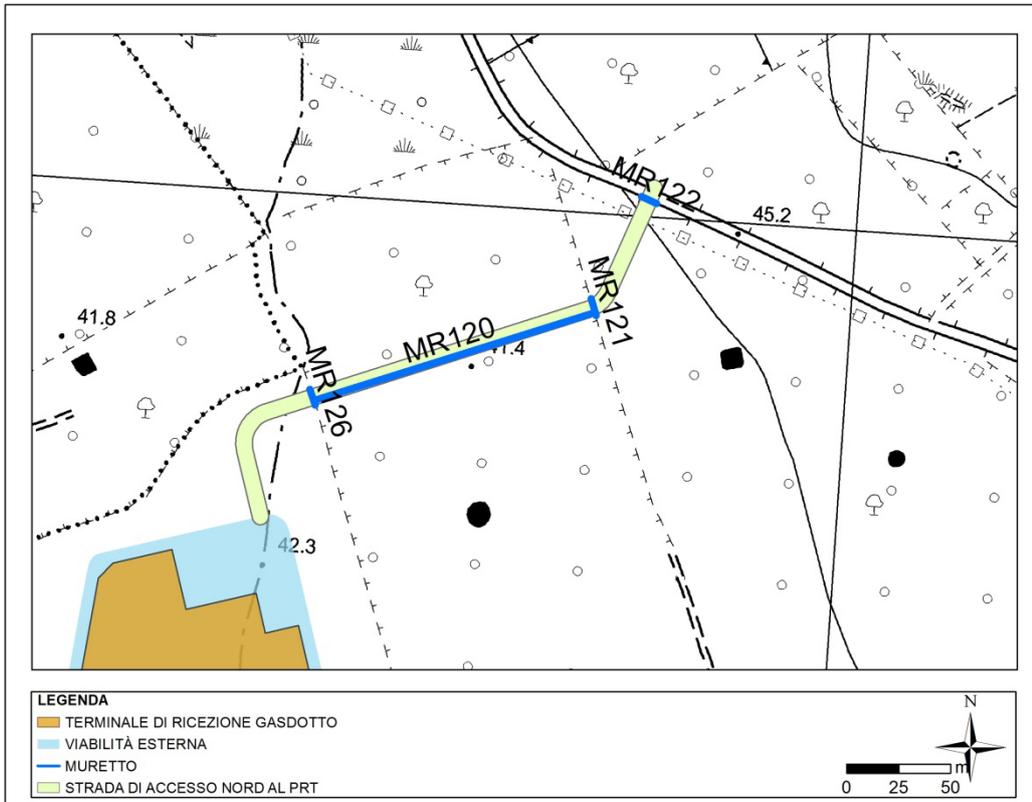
Muretti Interferiti dall'Area di Cantiere del PRT
